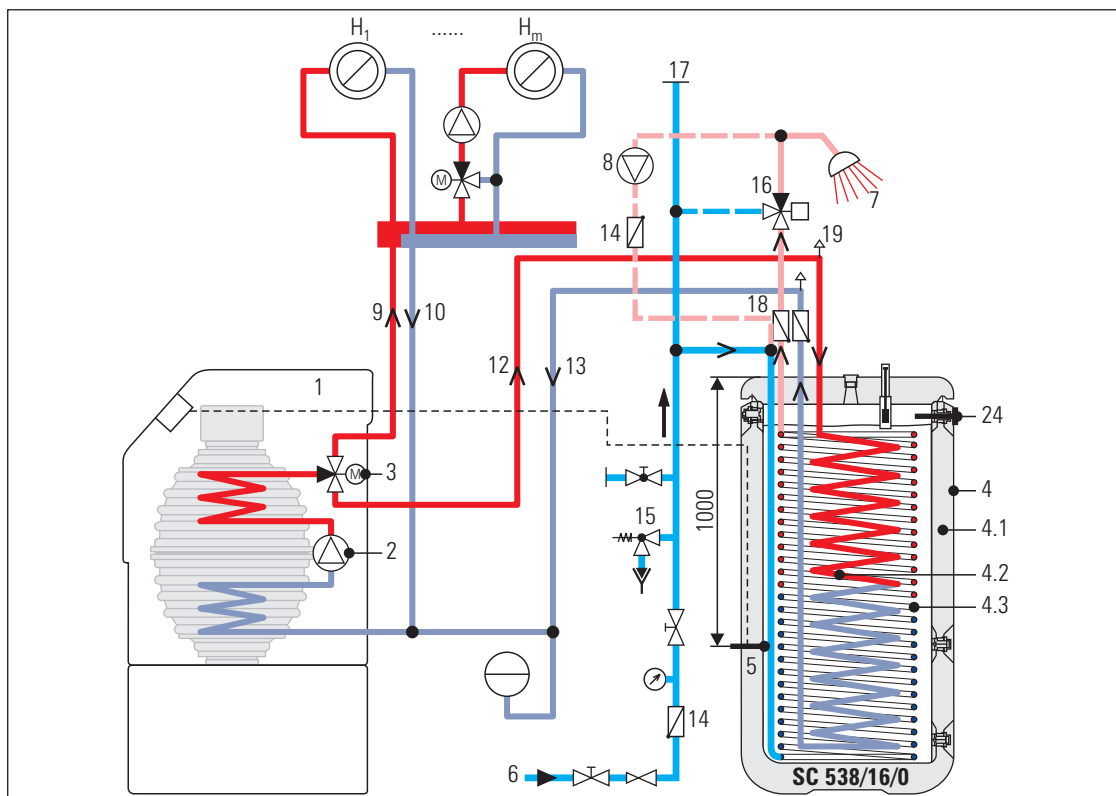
Schema di collegamento standard ROTEX Sanicube¹⁾
